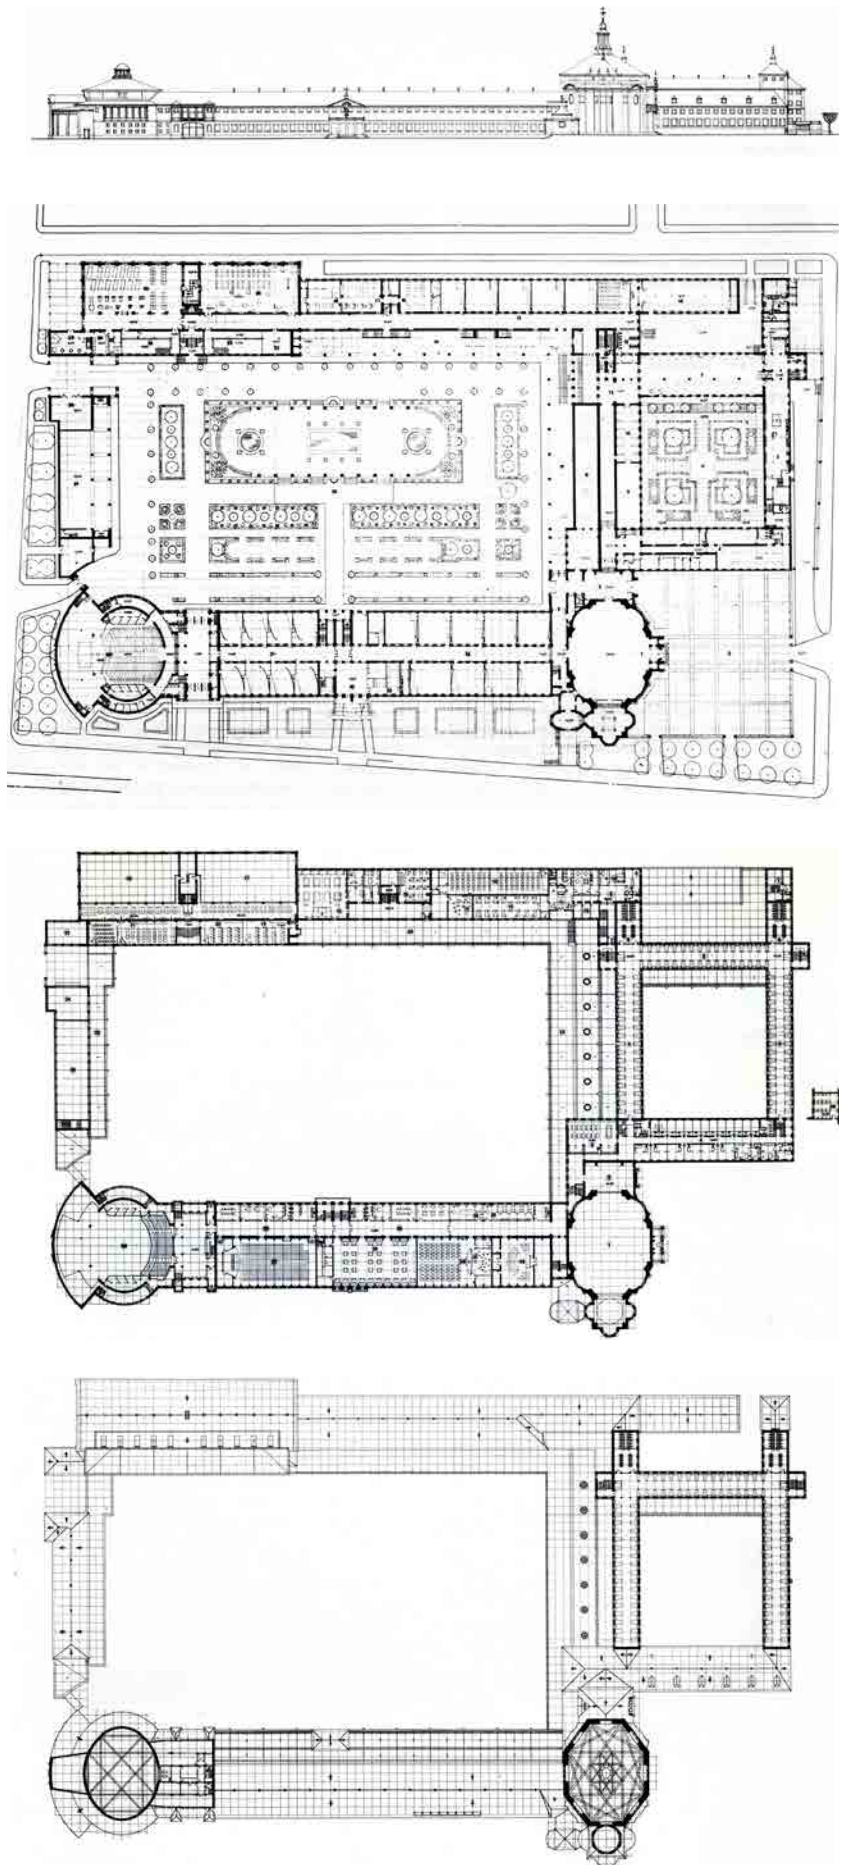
, Fig. 5, Fig. 6 y Fig. 7 De arriba a abajo: alzado de la fachada Este, planta baja, planta primera y planta segunda o de cubiertas.
